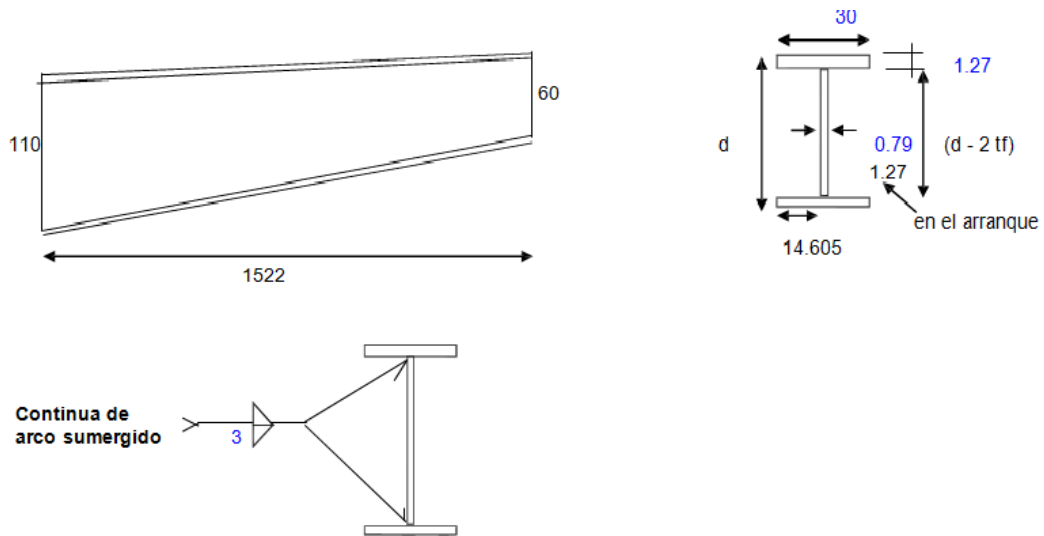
Detalle soldaduras en traves.
